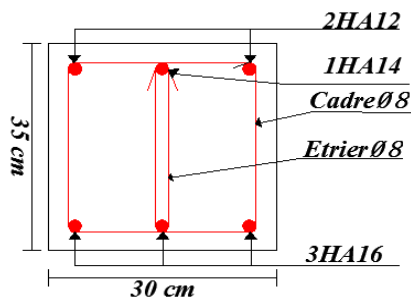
Schéma de ferrailage de la Poutre de chaînage en travée
